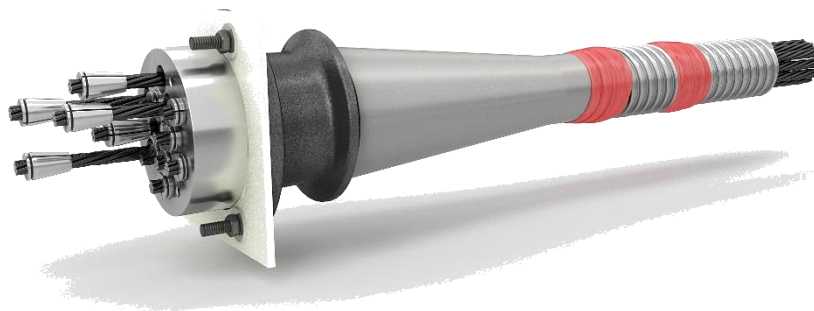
Общий вид анкерного узла для системы преднапряжения «на бетон».
